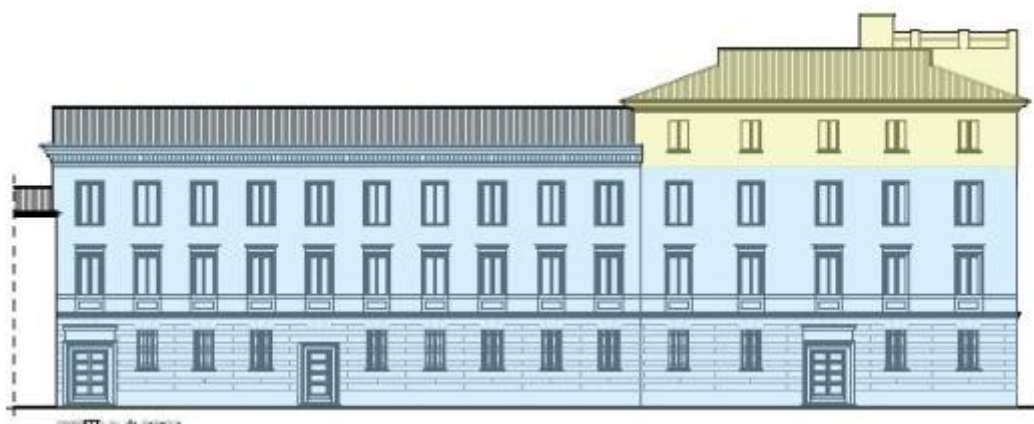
Prospetto via Baracca, individuazione corpo originario e successiva sopraelevazione
